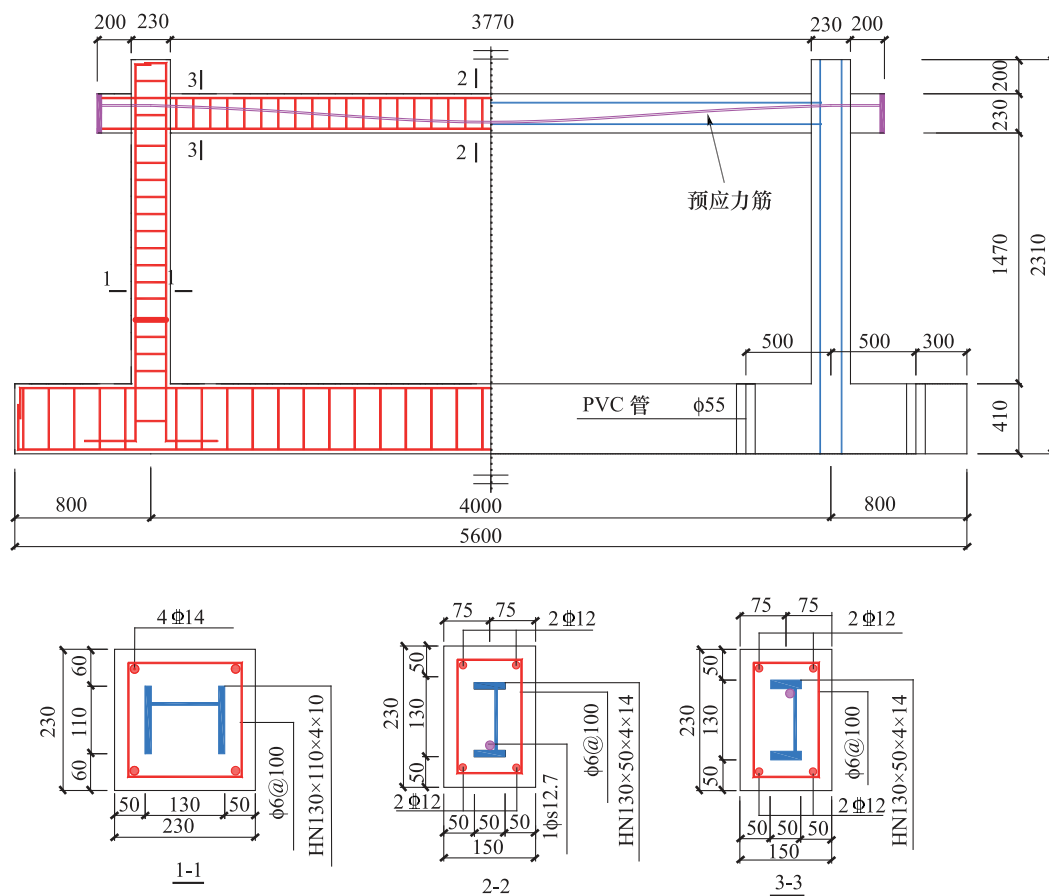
预应力型钢混凝土框架具体参数示意图 (mm)
